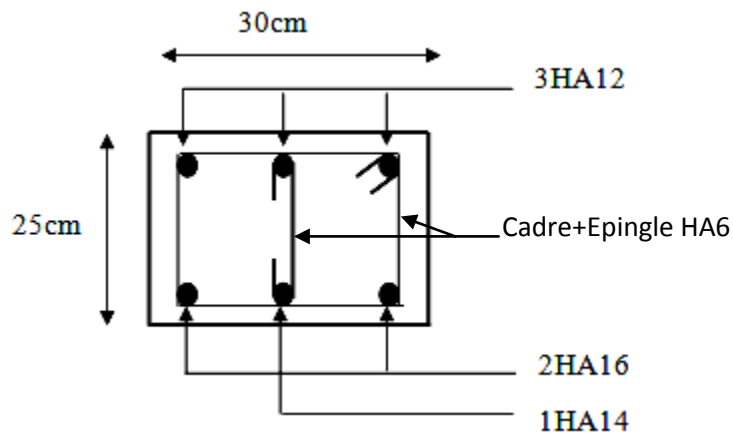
Schéma de ferrailage de la poutre de chaînage type I.
